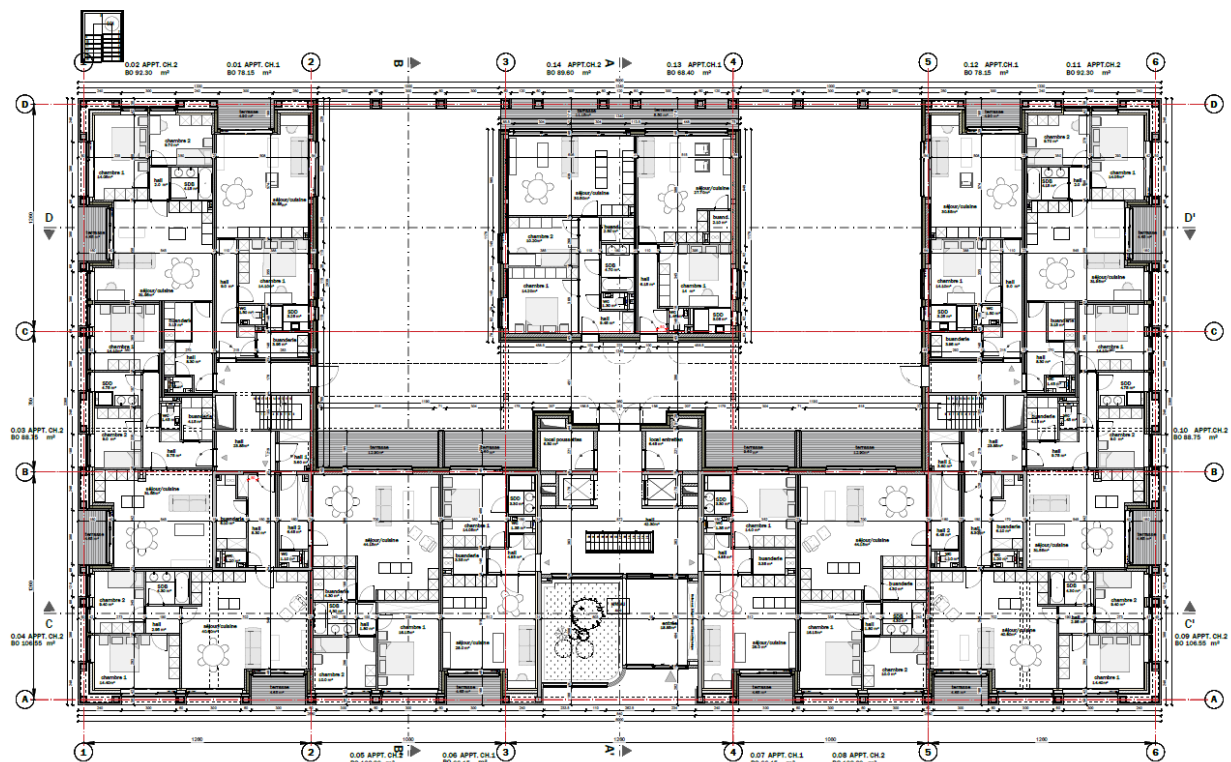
Extrait du plan du rez-de-chaussée (source : ARTER Architects)
